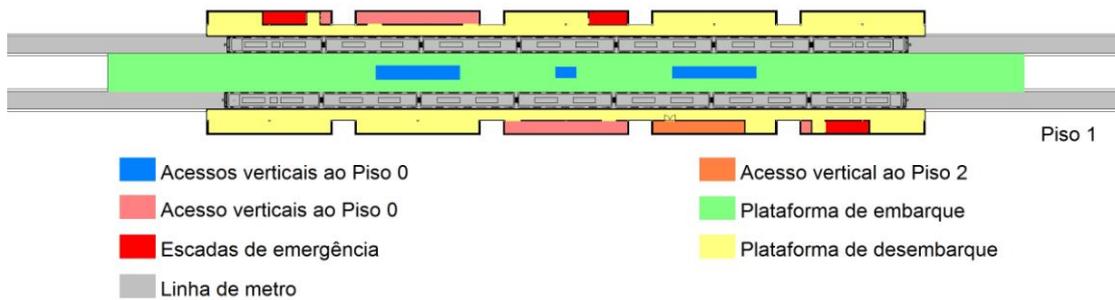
Estação proposta da Zona Franca Litoral- planta geral do Piso 1
